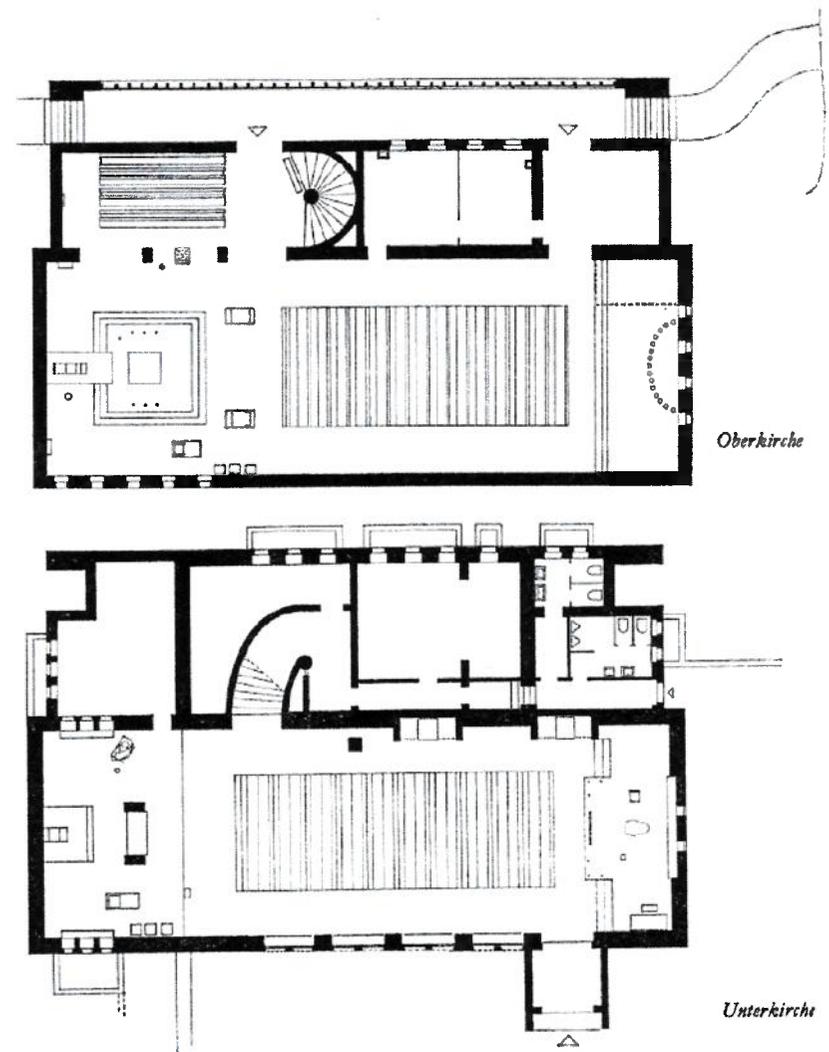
Die geosteten Grundrisse der Unter- und Oberkirche sowie des östlichen Anbaus.
